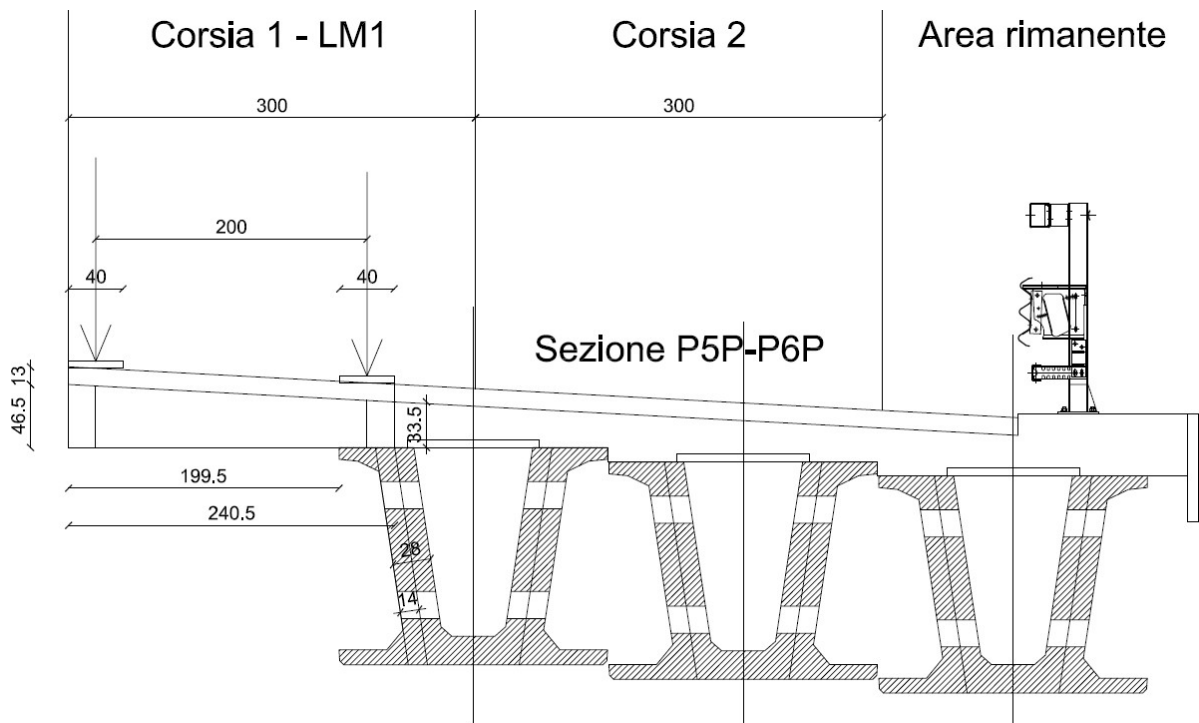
Sezione trasversale di verifica tipo F3
